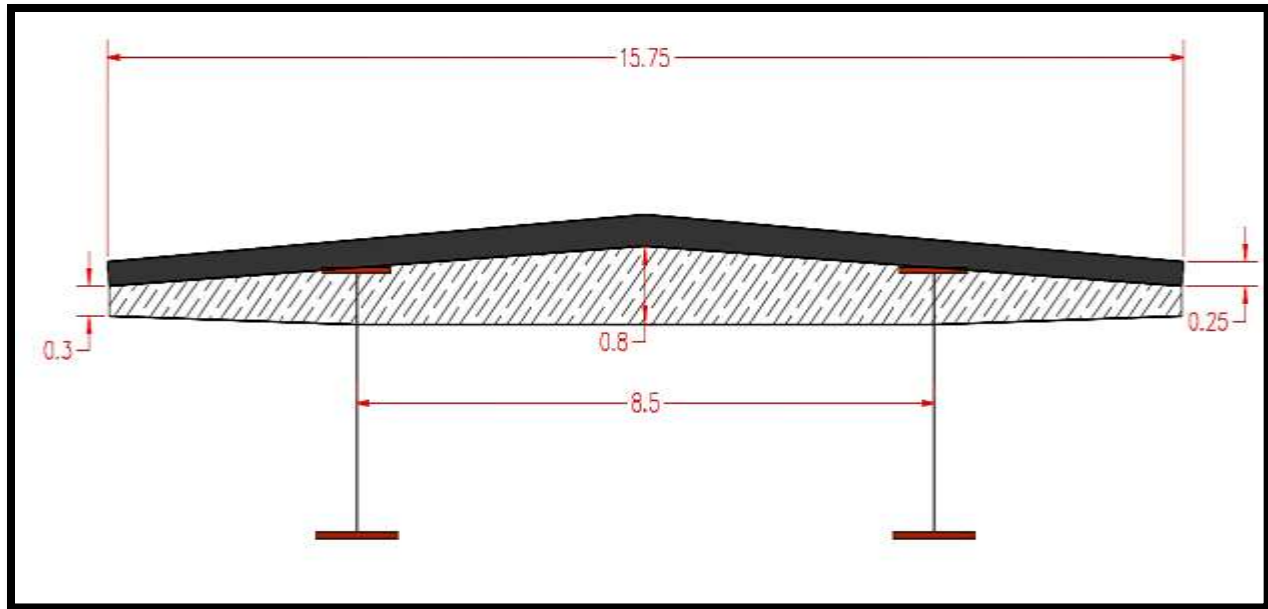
Paramètres du dimensionnement d'un bipoutre à pièces de pont avec consoles.
